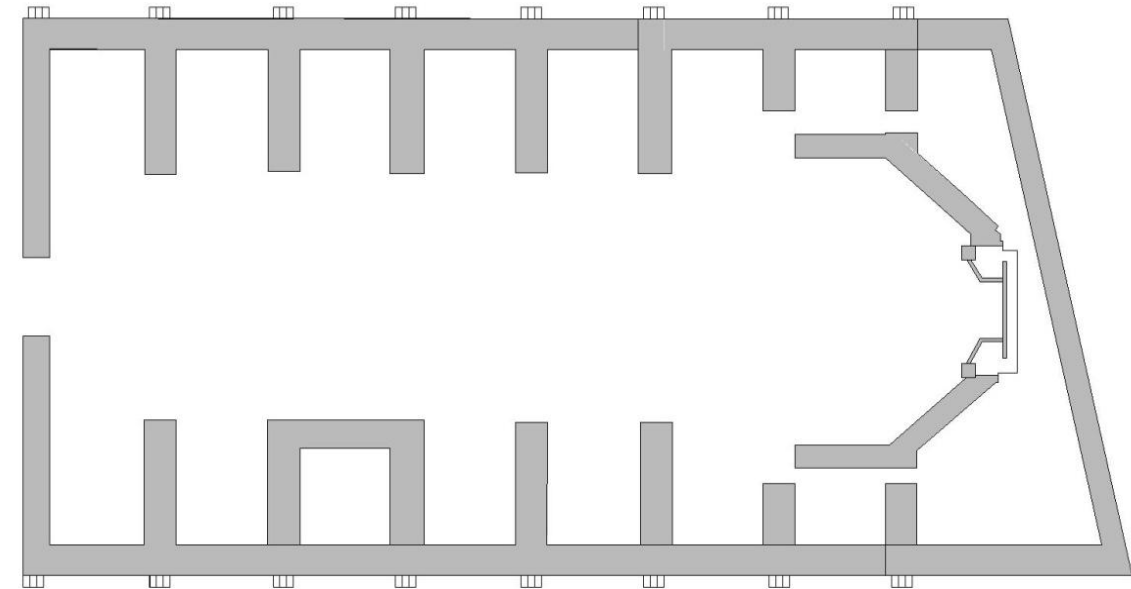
Imagen planta año 1.630. Fuente: (propia)
